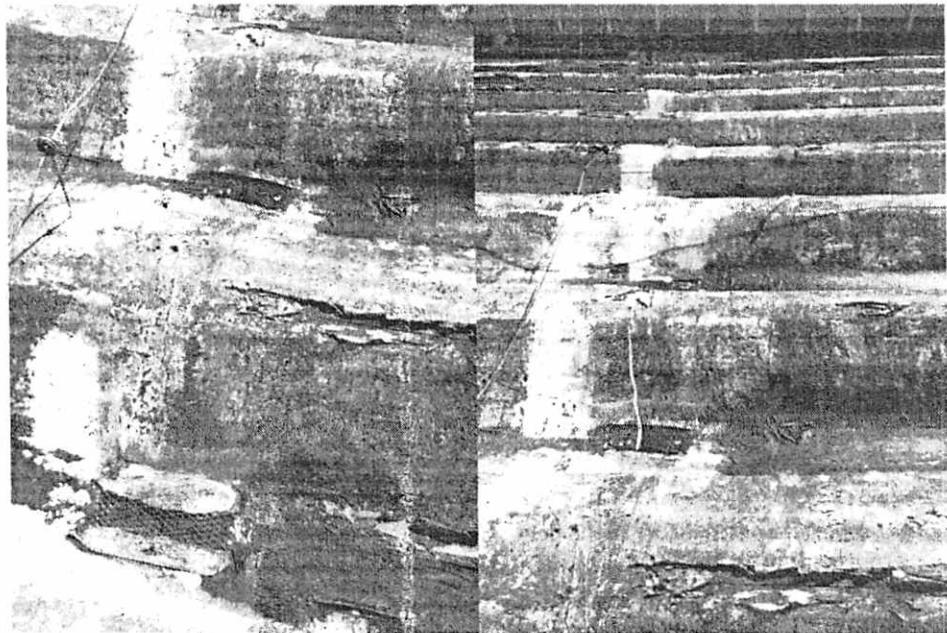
Detalhe do telhado que apresenta sinais de desgaste e a necessidade da execução de reparos em pontos localizados.
